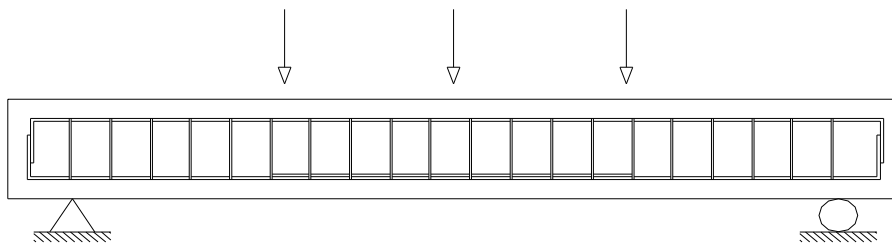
Falla de una viga de concreto sometida a tracción.
